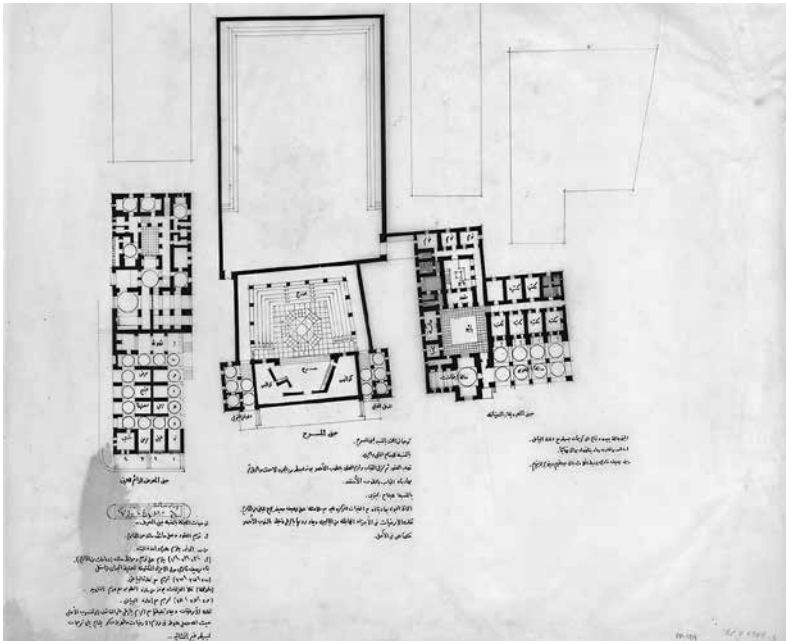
Grundrissplan des Theaters von New Gurna.
